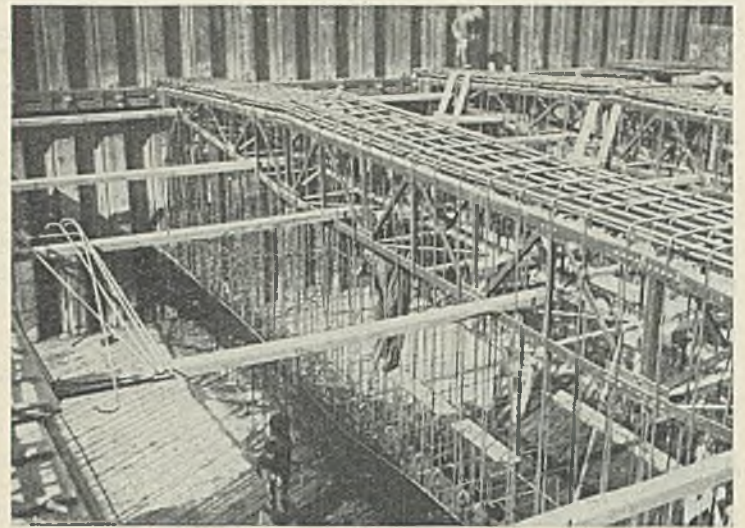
Mole, Rundeisenbewehrung der Rippen.
